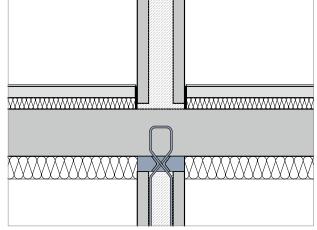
Représentation schématique d'un système Schöck Sconnex® type W pour doubles murs et isolation sur la dalle
